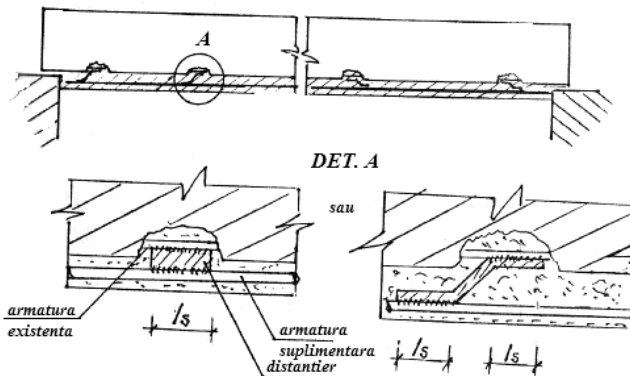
Consolidarea grinzilor din beton armat prin suplimentarea armăturilor în câmp [76]
